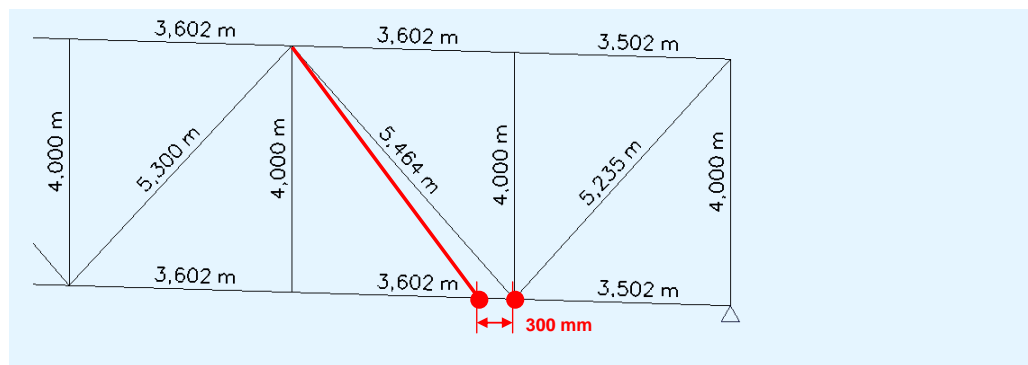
Passage d'un conduit – Excentrement d'une diagonale
